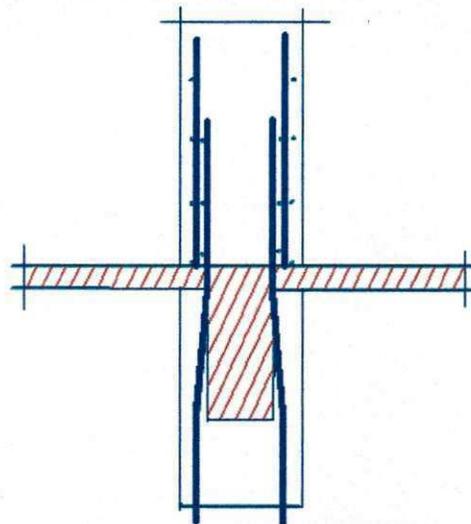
Ferro de espera dos pilares dobrados para o interior da continuidade do pilar.
